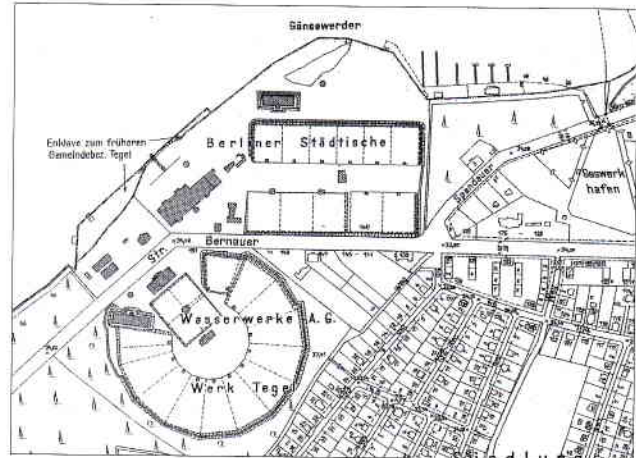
Lageplan des Wasserwerks am Tegeler See.
